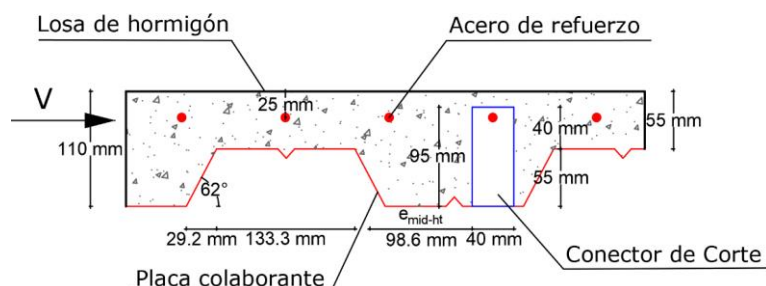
Dimensionamiento de la losa y el conector. Fuente: Los autores
